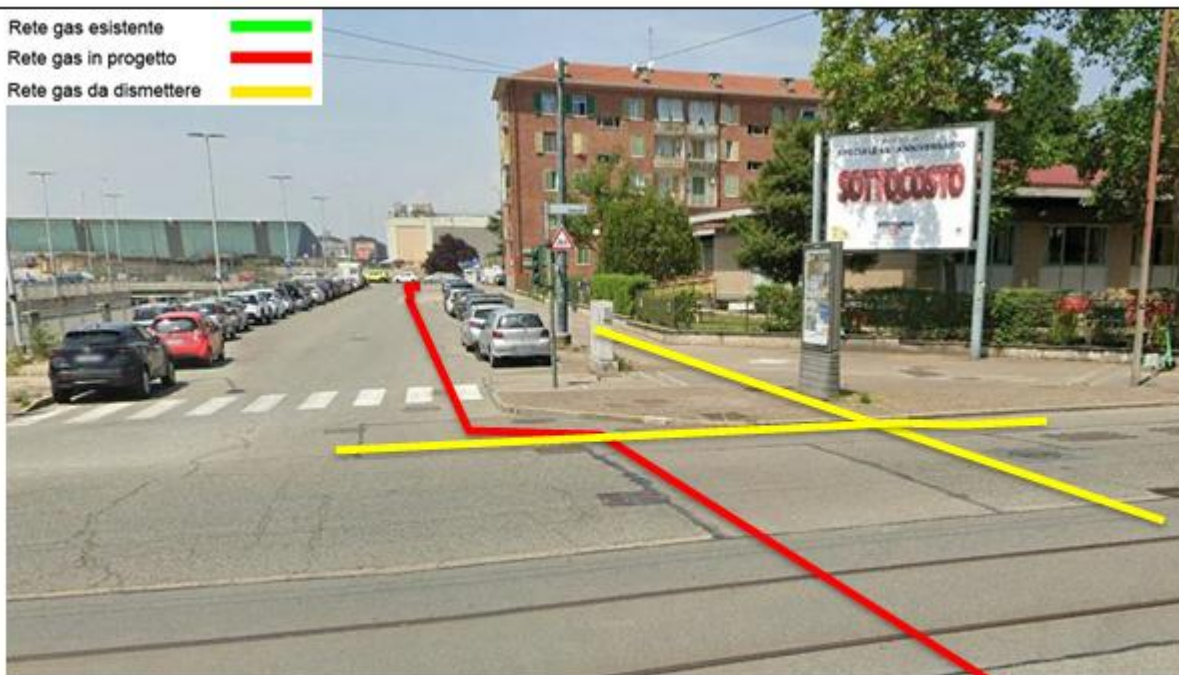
Percorrenza condotta Caduti sul Lavoro attraversamento Via Genova
